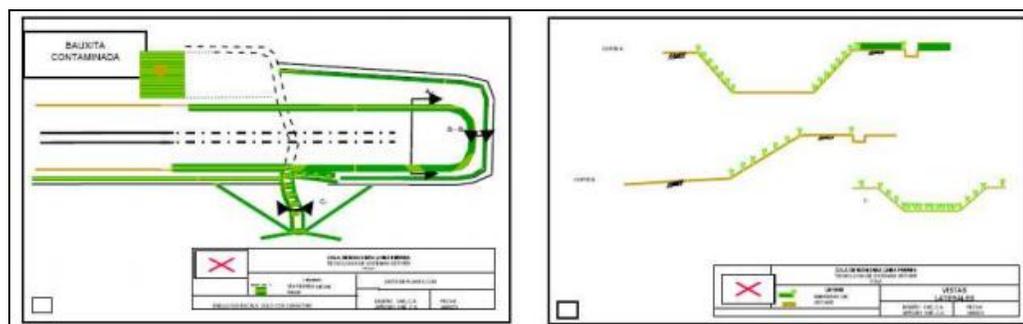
Plano de diseño (Fuente: C.V.G- BAUXILUM)
